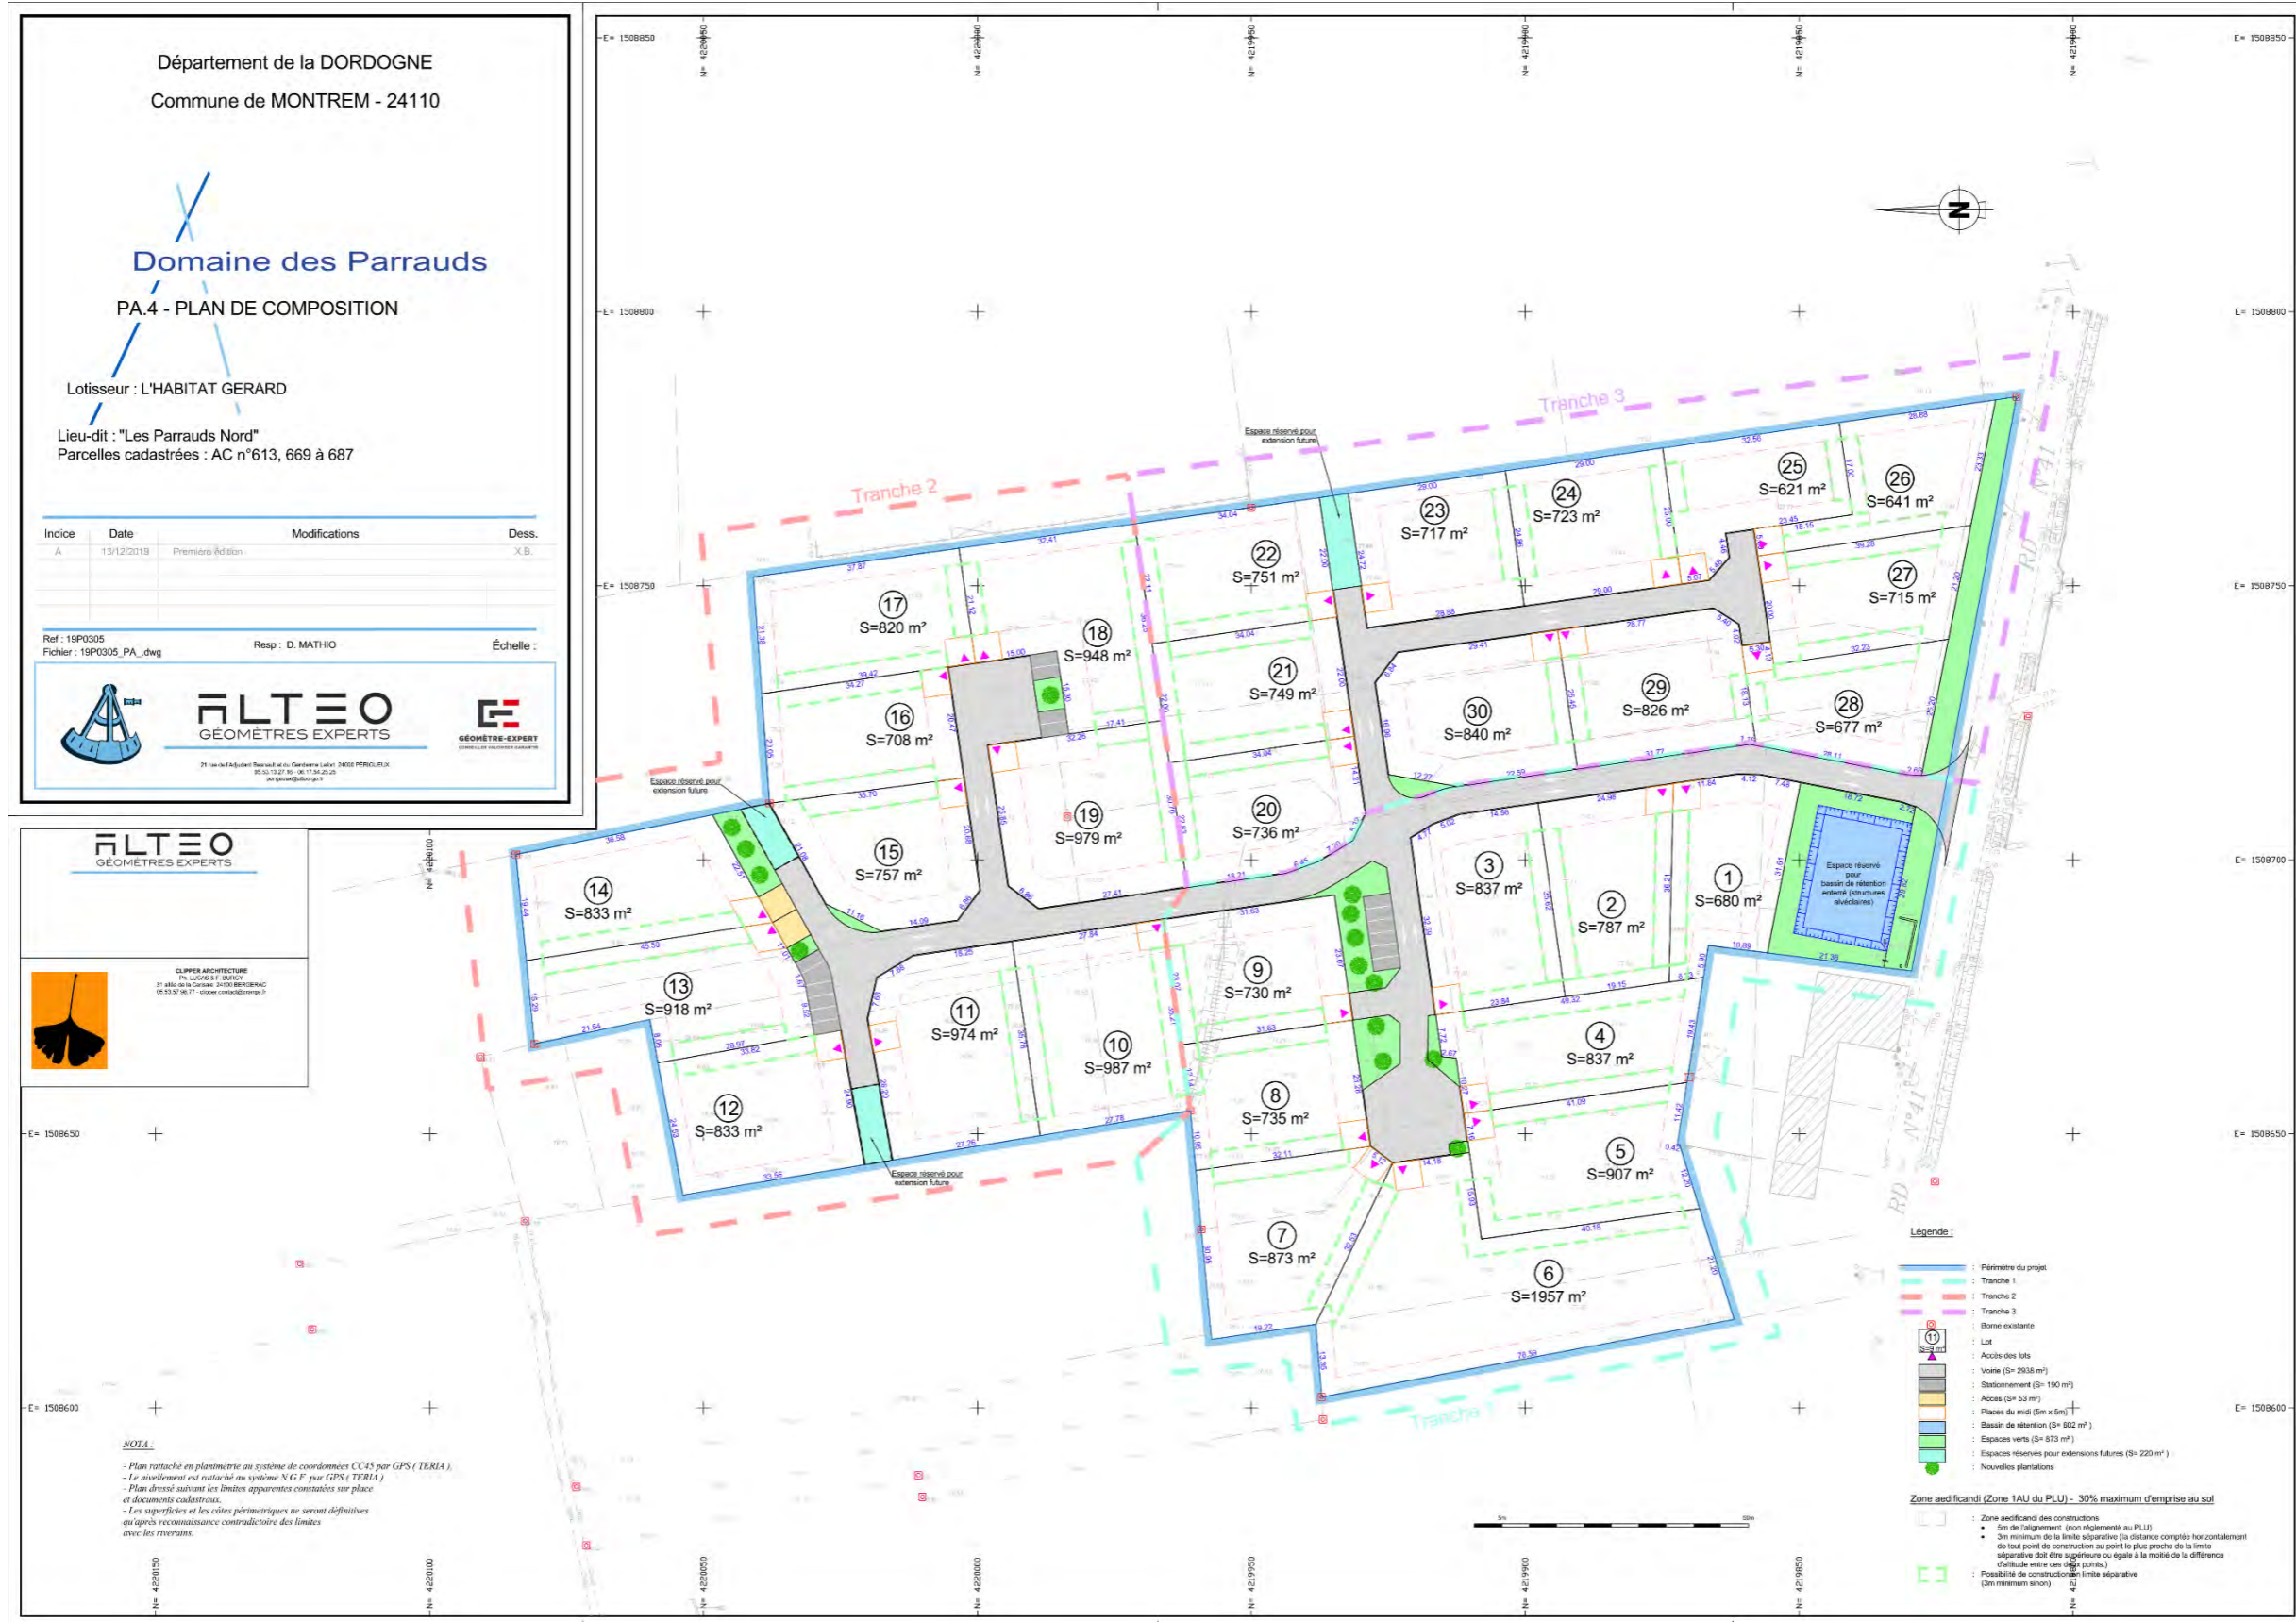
Plan de « masse » du projet (Altéo Géomètre)
